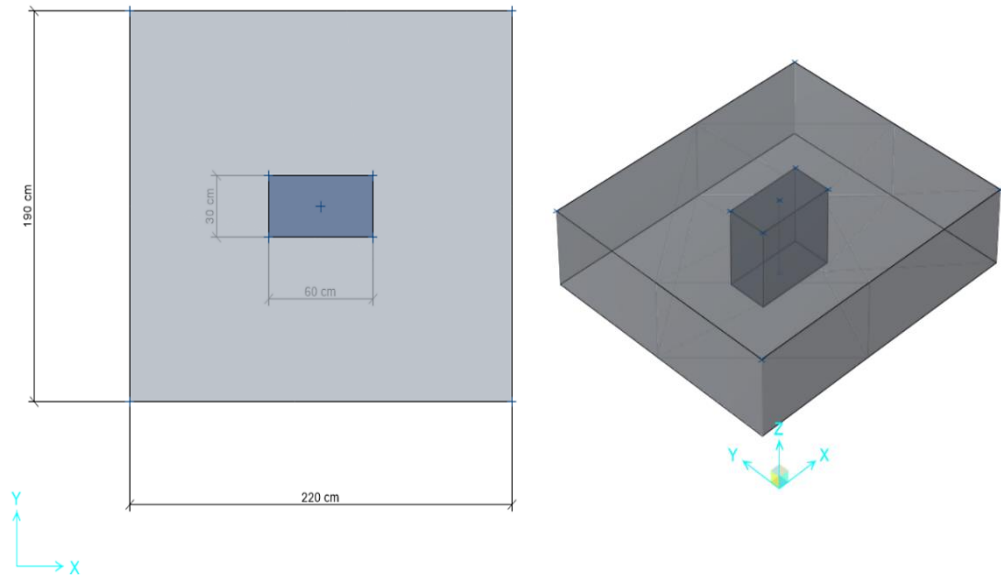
Modelo estructural de la cimentación vista en planta y en 3D (Zapata-geotextil)
